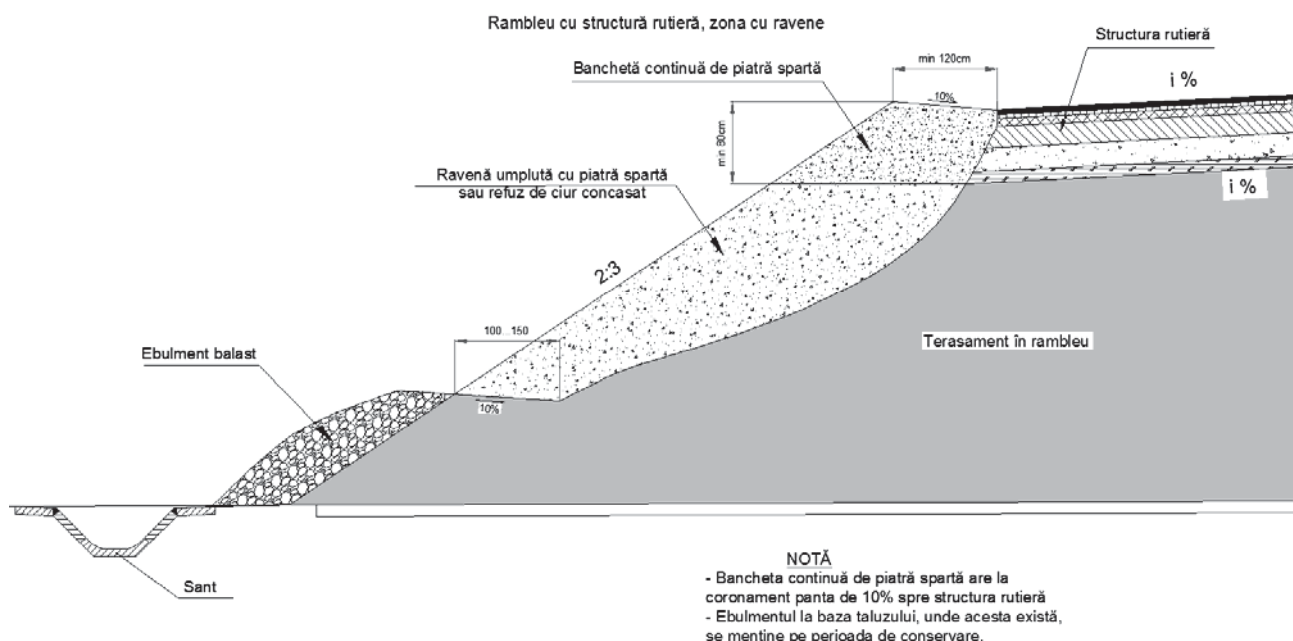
Închiderea ravenelor cu piatră spartă - zona cu structură rutieră
